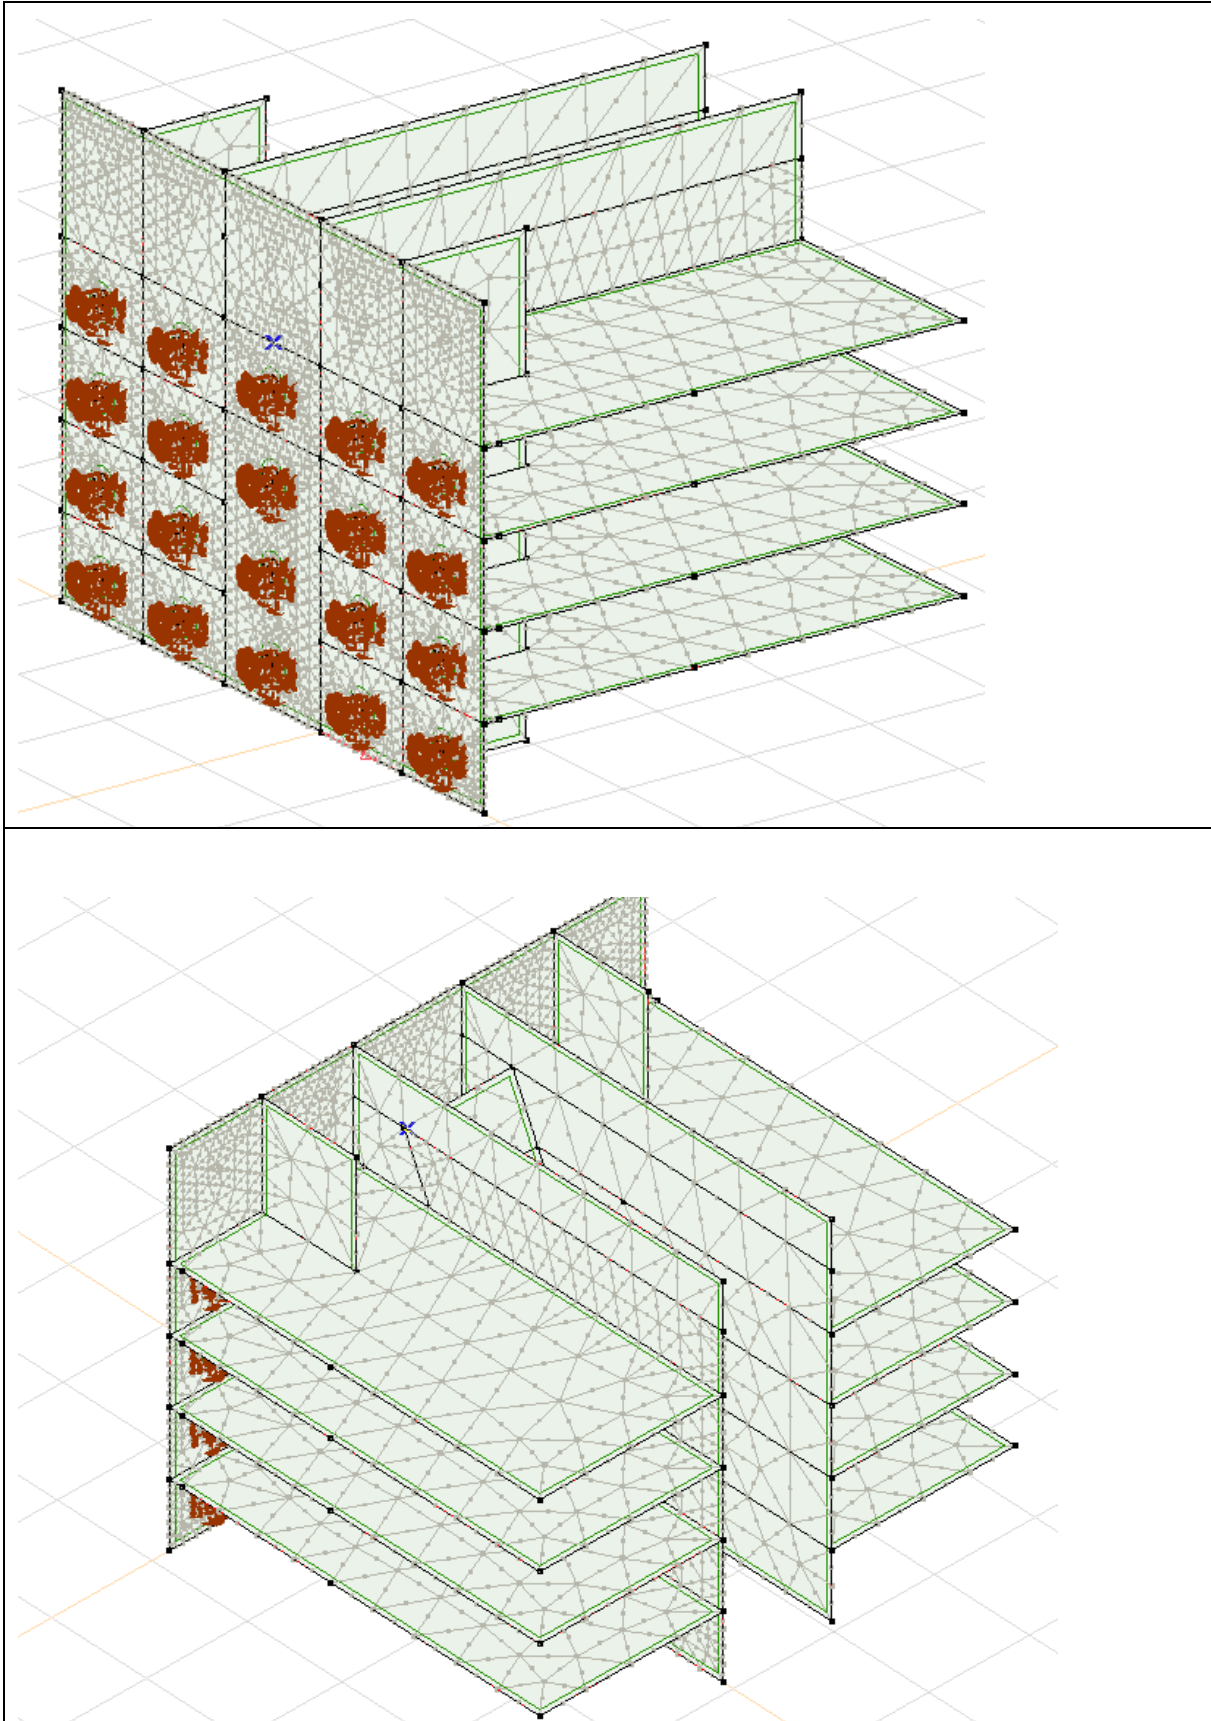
Geometria ritegno longitudinale su spalla
